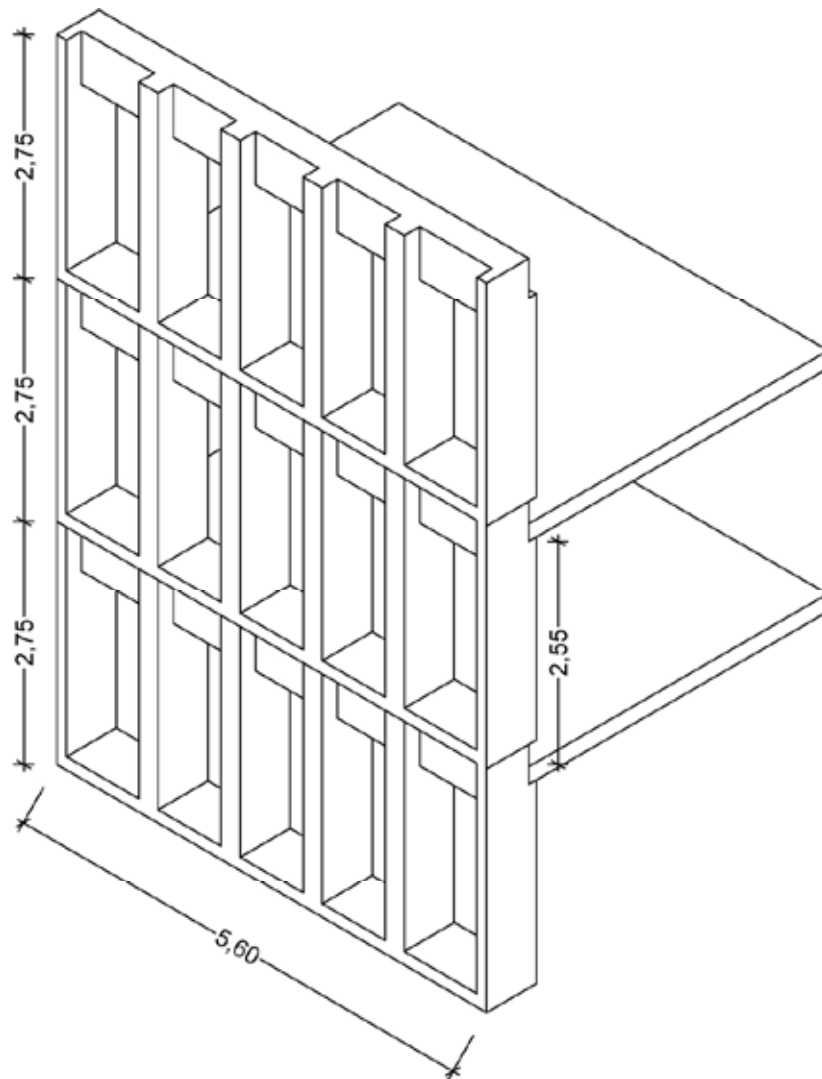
Detalles del fragmento de la fachada y la unión con la losa del forjado
